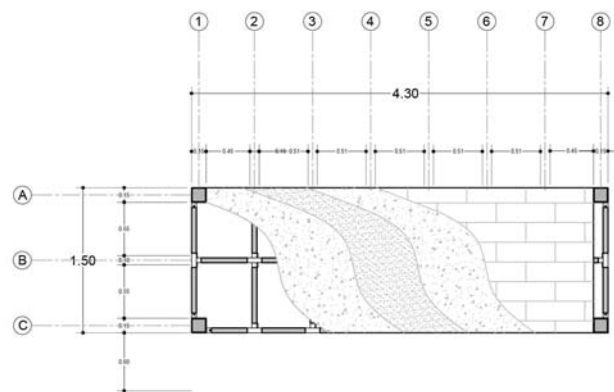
Nelly Hernandez (2018) Planta albañilerías (plano).
